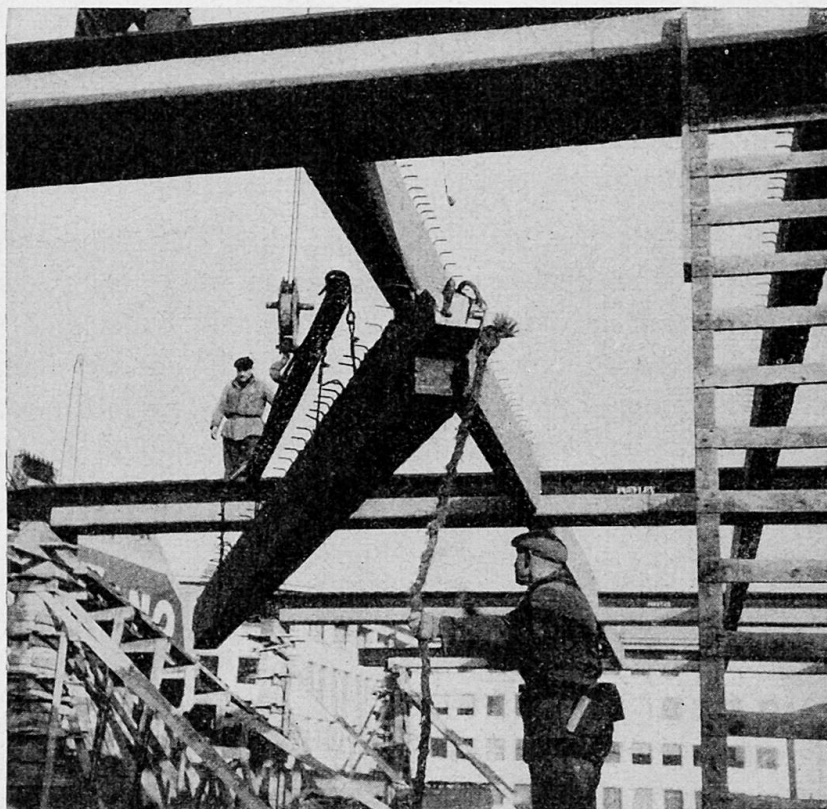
Office National du Placement et du Chomage à Bruxelles*. Mise en place des poutres préfabriquées en béton armé d'une longueur de 7,50 m sur les poutres Préflex ayant une portée de 15,00 m.
